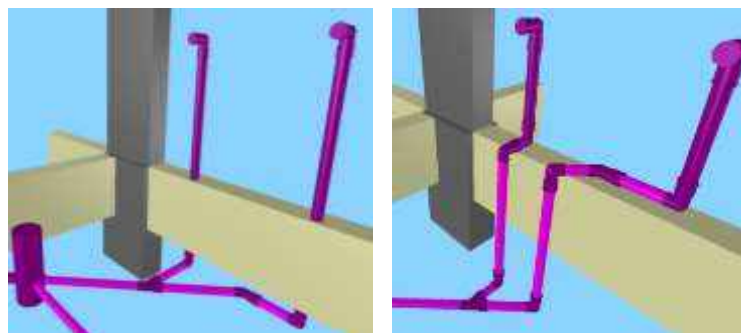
Incompatibilidade Hidrossanitário x Estrutural: tubulação de esgoto da pia e da máquina de lavar roupas x viga (apartamentos lado direito)
